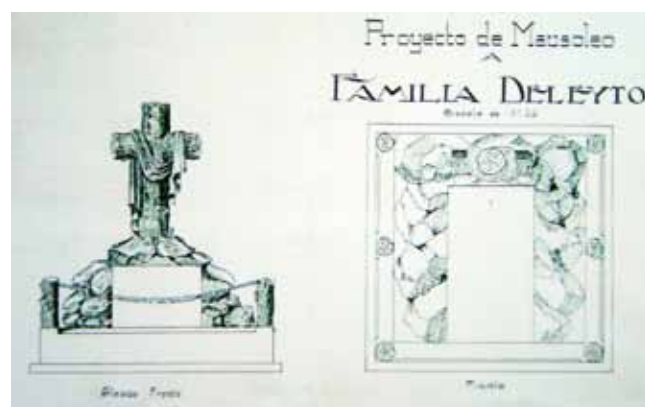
Proyecto del mausoleo de la familia Deleyto, Gijón.
